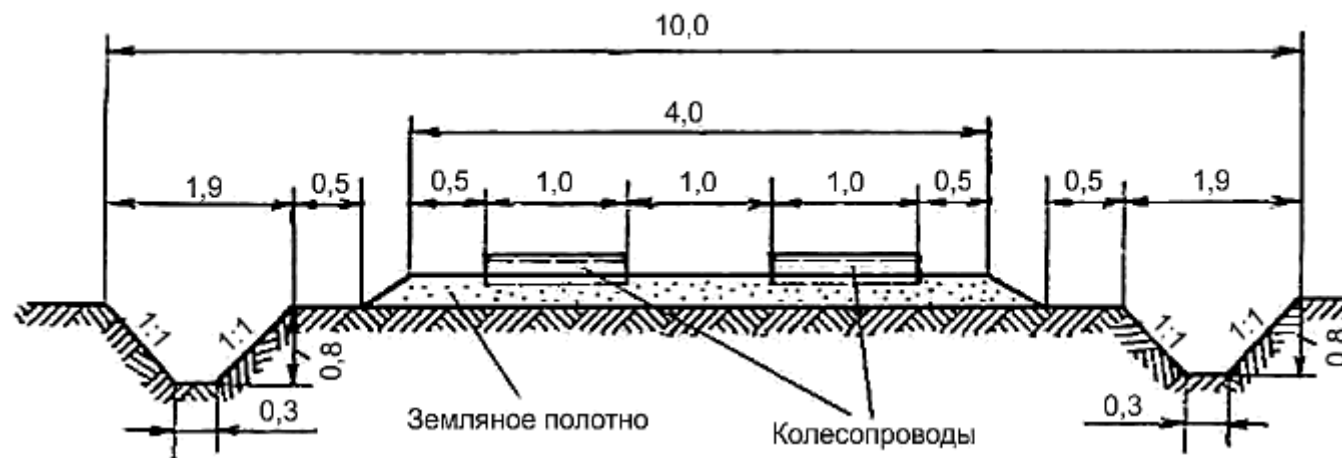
Поперечный профиль лесных дорог из железобетонных плит для условий типа местности II на грунтах, годных для укладки в земляное полотно
